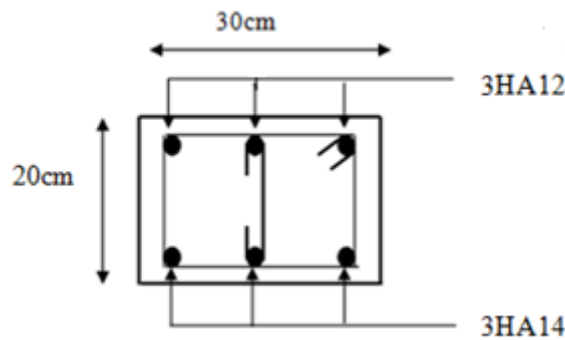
Schéma de ferrailage de la poutre de chaînage type I.
